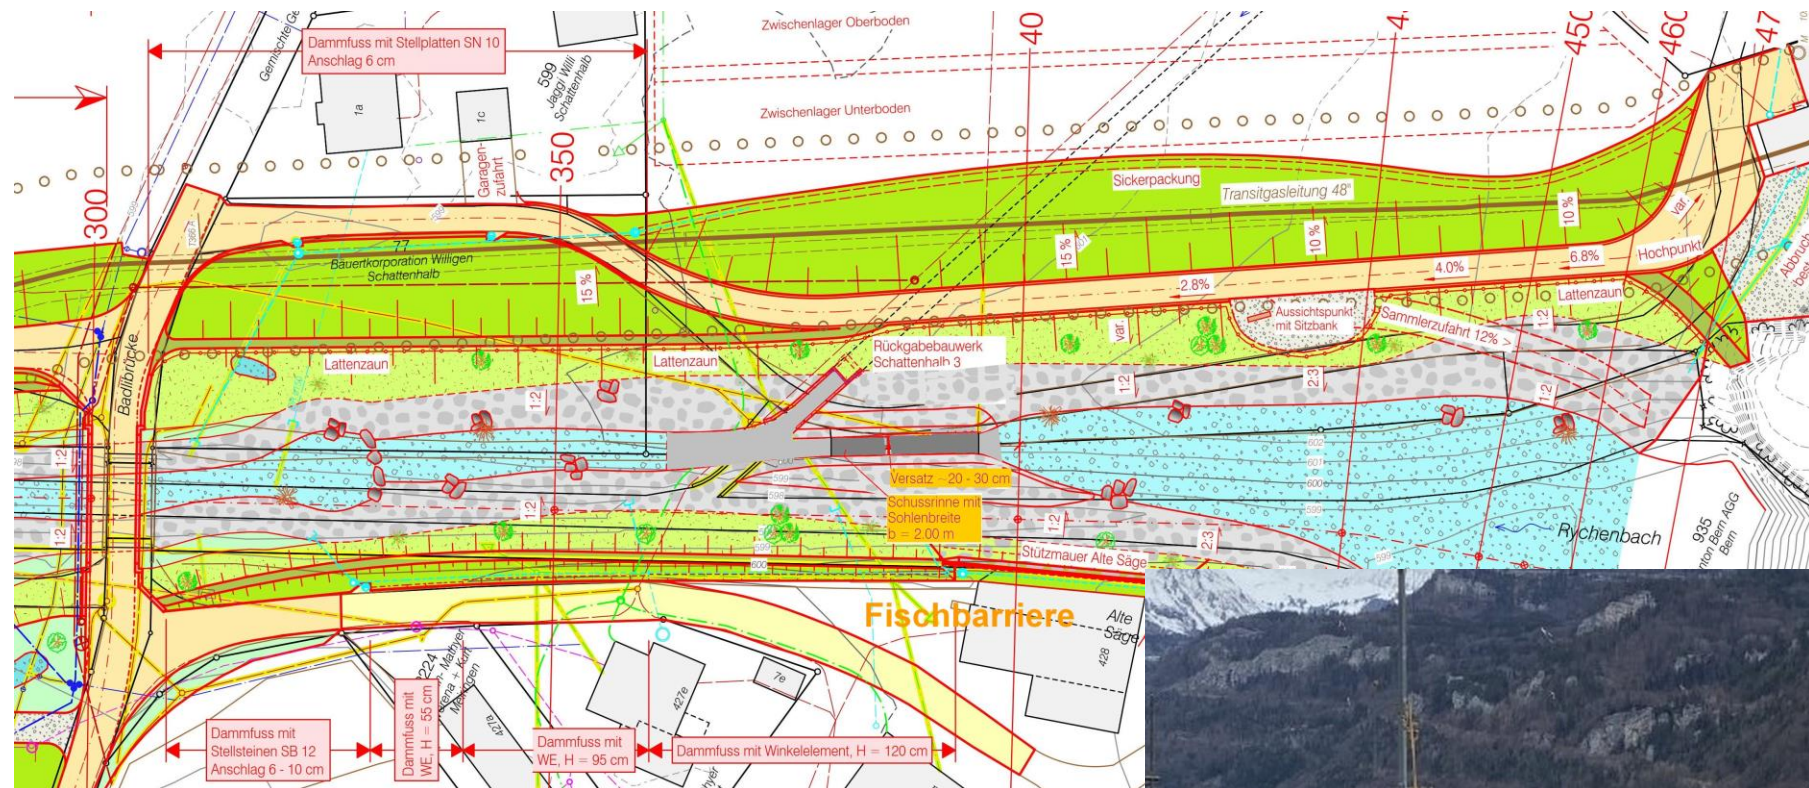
Auszug Plan Situation 1:500, Revitalisierung Rychenbach, Baulos 1, Ausführungsprojekt, Rev. Aug. 201,9 Plan.-Nr. 3214-21B, dunkelgrau eingefärbt, Fischsperre mit Schussrinne und Absturz (Versatz 20-30 cm), hellgrau gepflästerte Sohle, damit sich kein Kolk unterhalb der Schussrinne bilden kann (Verhinderung Fisch"anlaufstelle" und damit sich kein Geschiebe vor dem Auslaufbauwerk von SH3 ansammeln kann
